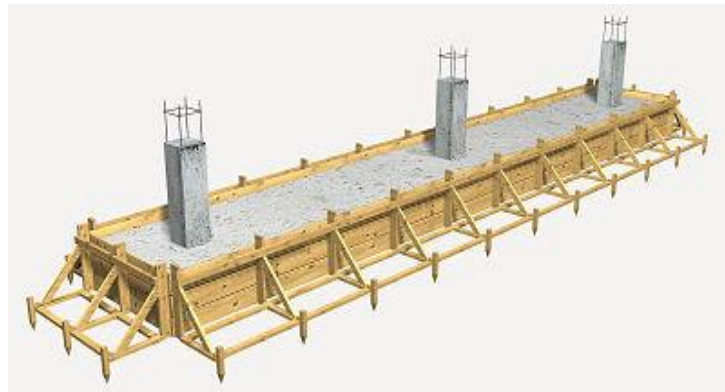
Schéma d'une semelle filante sous poteaux.
